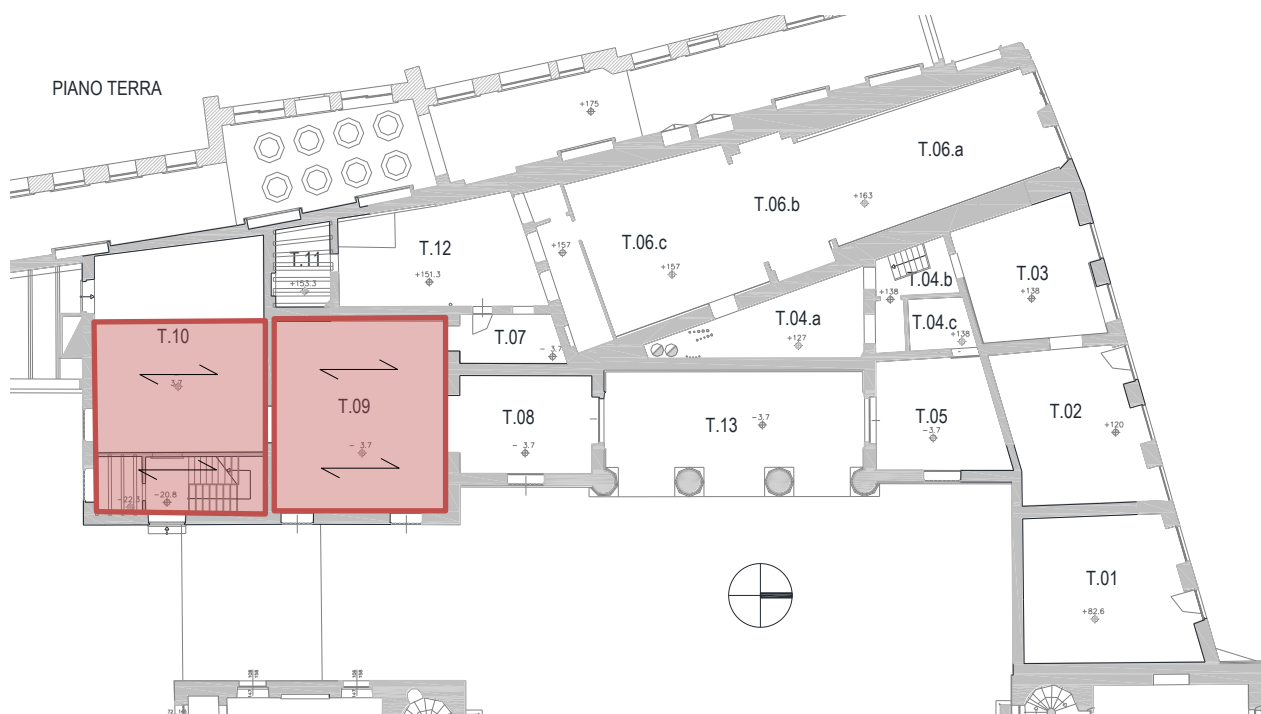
Localizzazione del solaio T.09-10.Aggiunto con direzione dei solai nella condizione di stato di progetto
